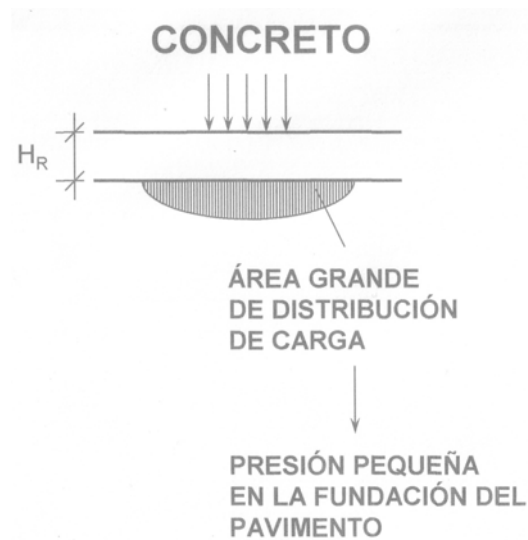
Distribución de Esfuerzos en un Pavimento Rígido.
